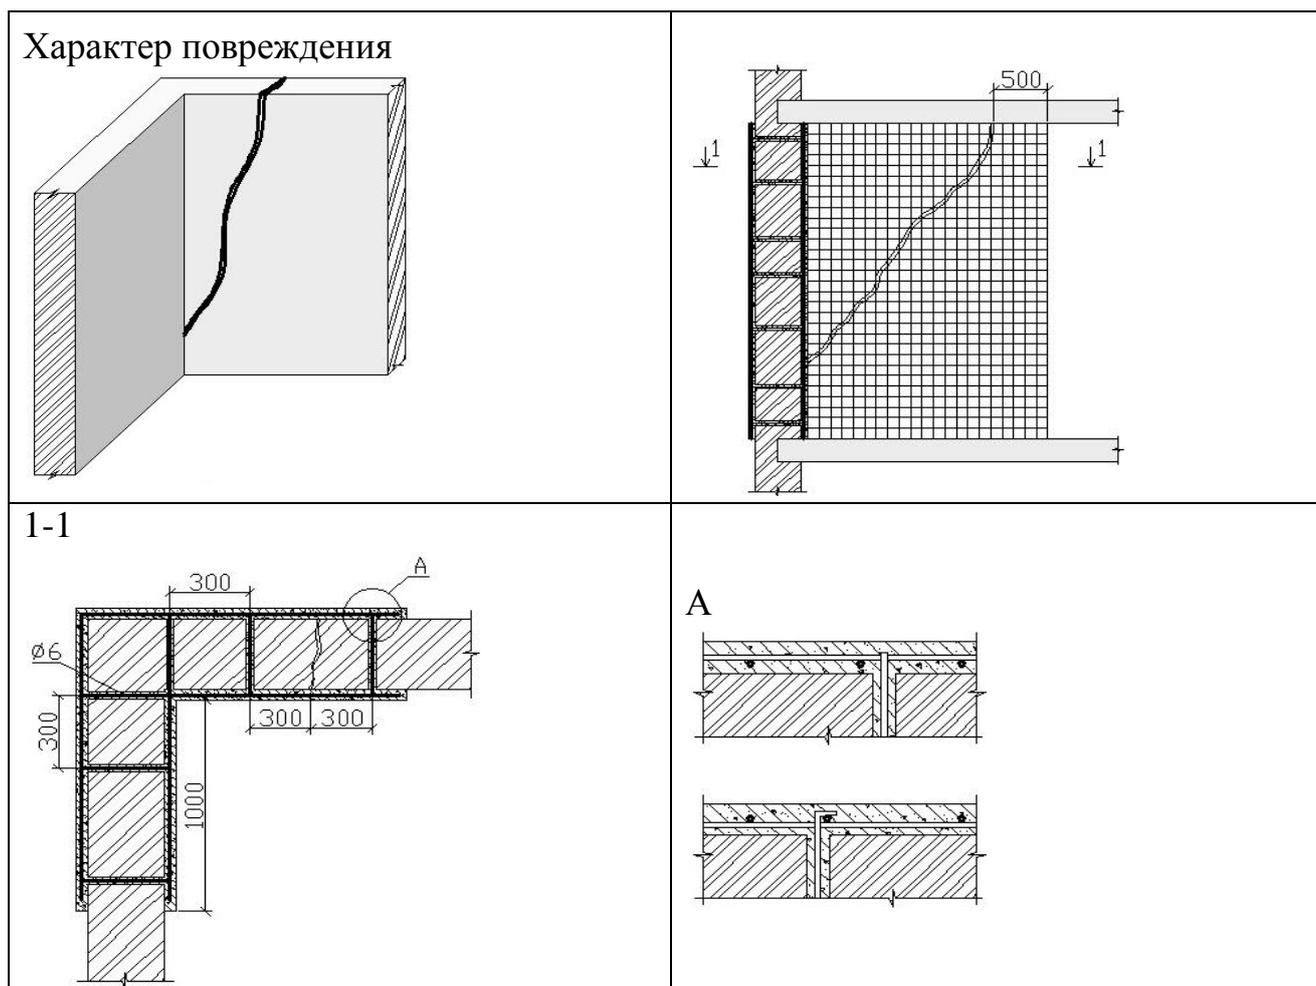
Усиление стен с диагональными трещинами, наклонными в местах их примыкания или в любом другом месте.
